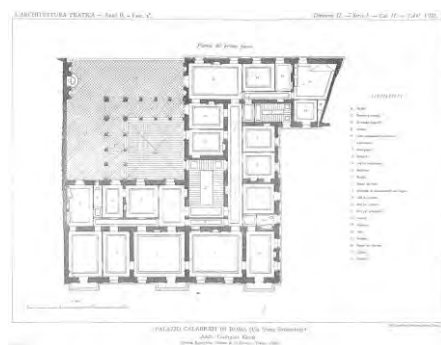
pianta piano primo da “L'Architettura pratica”, 1891
